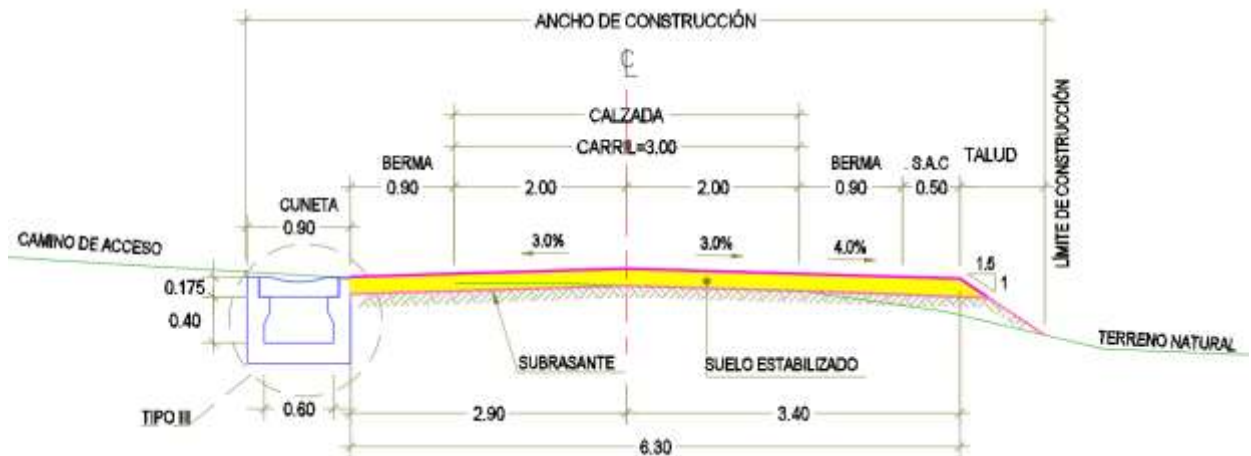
Sección típica a media ladera con cuneta rectangular. Fuente: Planos Secciones Típicas.
